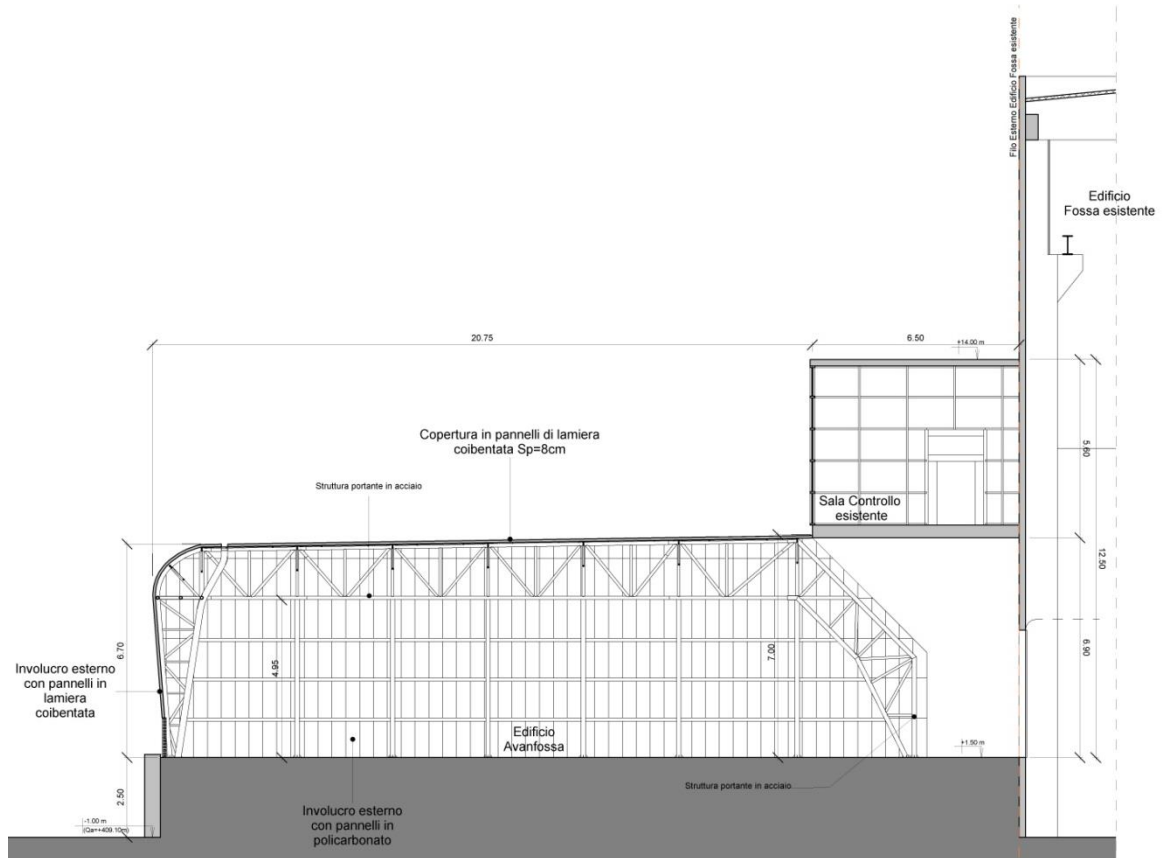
Sezione trasversale Edificio Avanfossa – stato di progetto
